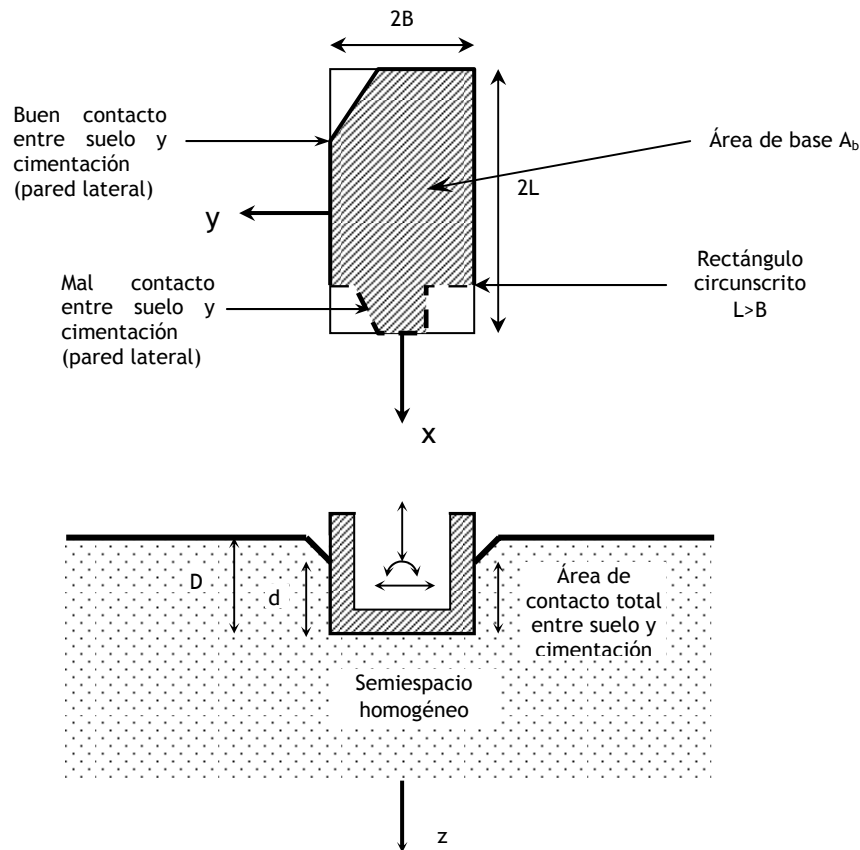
Cimentación con geometría arbitraria, embebida en el terreno
